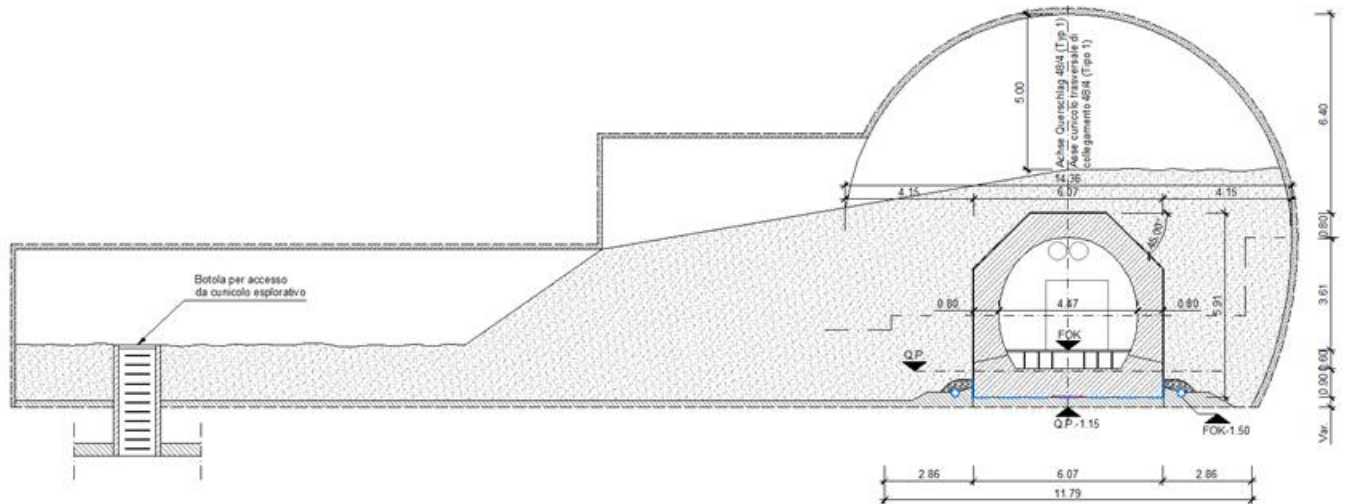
Zertrümmerungskammer und Anschlussstunnel - Endregelung [98].
